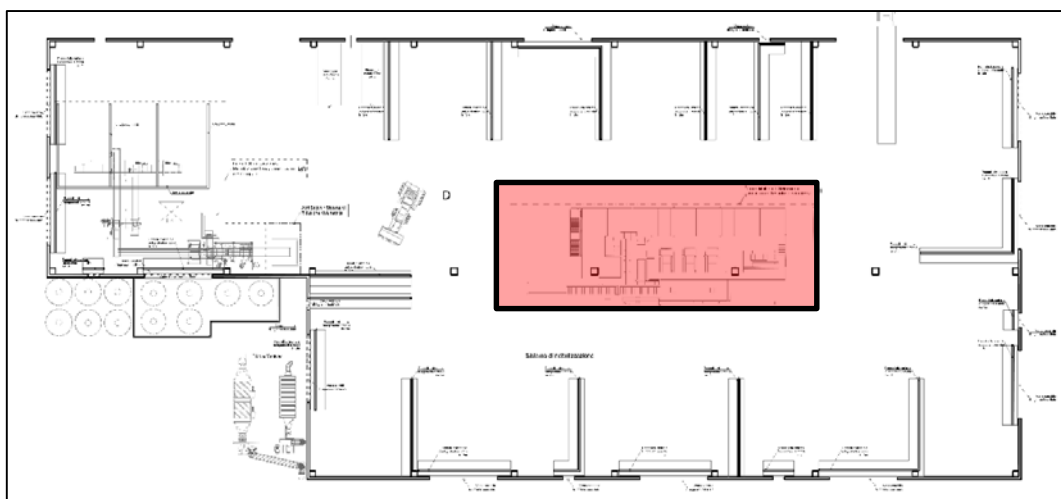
Stralcio Allegato S - Planimetria generale dell'impianto - Stato autorizzato
